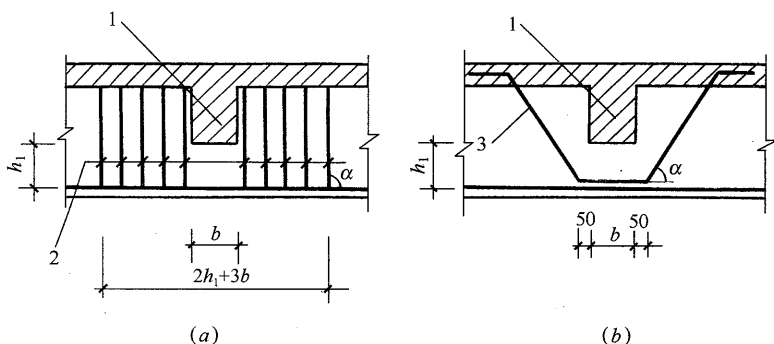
梁截面高度范围内有集中荷载作用时附加横向钢筋的布置
